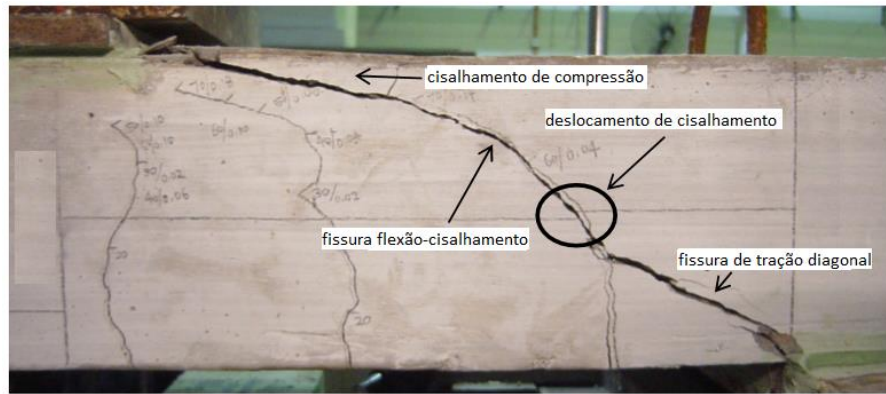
Padrão típico de fissuração das vigas de concreto leve – série “R” (Juan, 2011).
